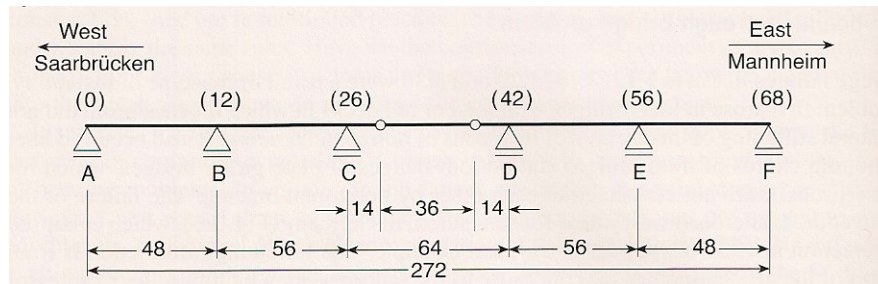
Esquema estrutural da ponte rodoviária Lauterbach
